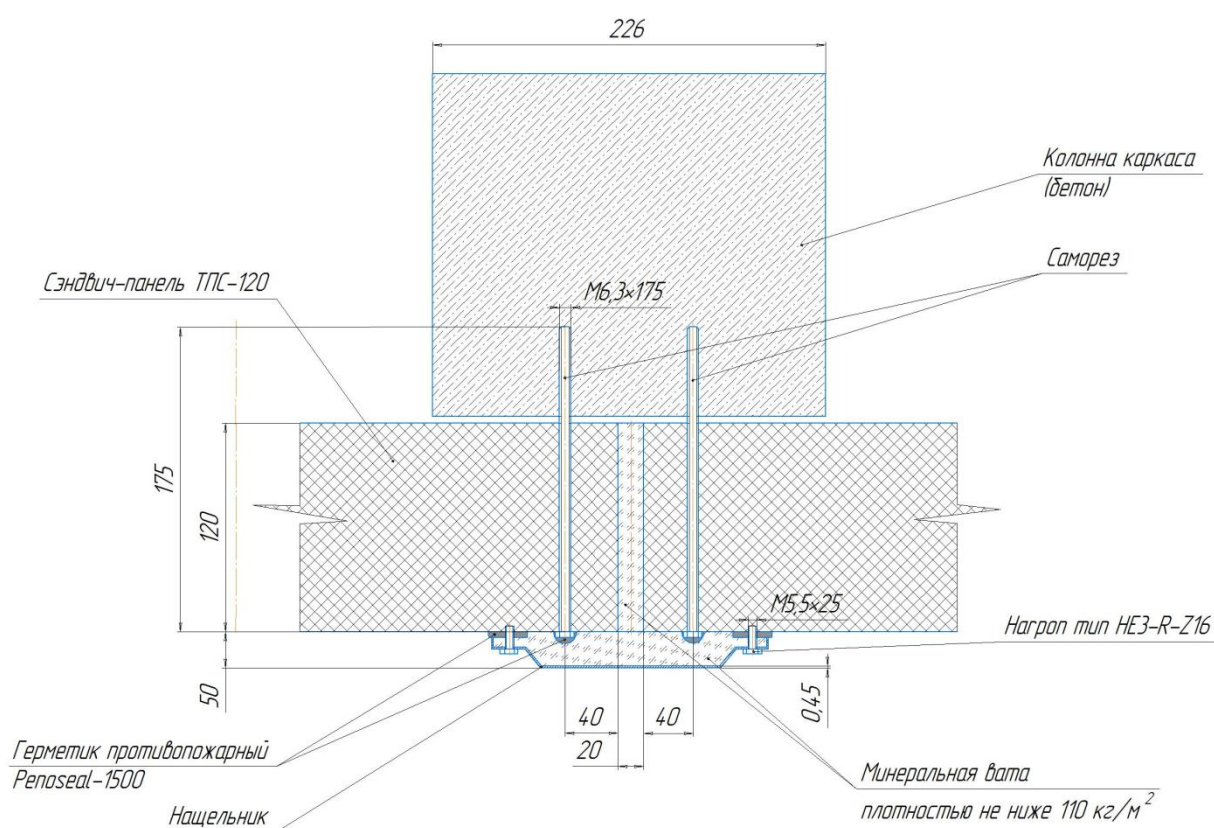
Крепление панелей к колонне каркаса (бетон)
